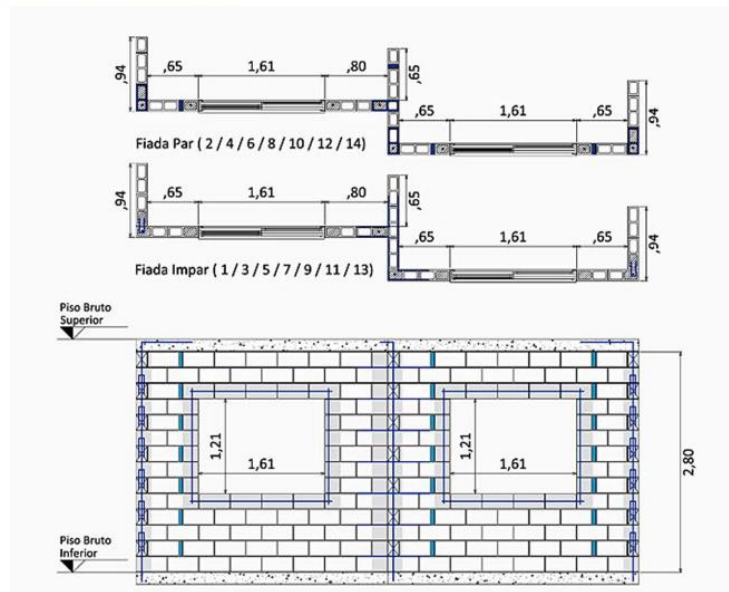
Alvenaria estrutural parcialmente armada de blocos vazados de concreto
